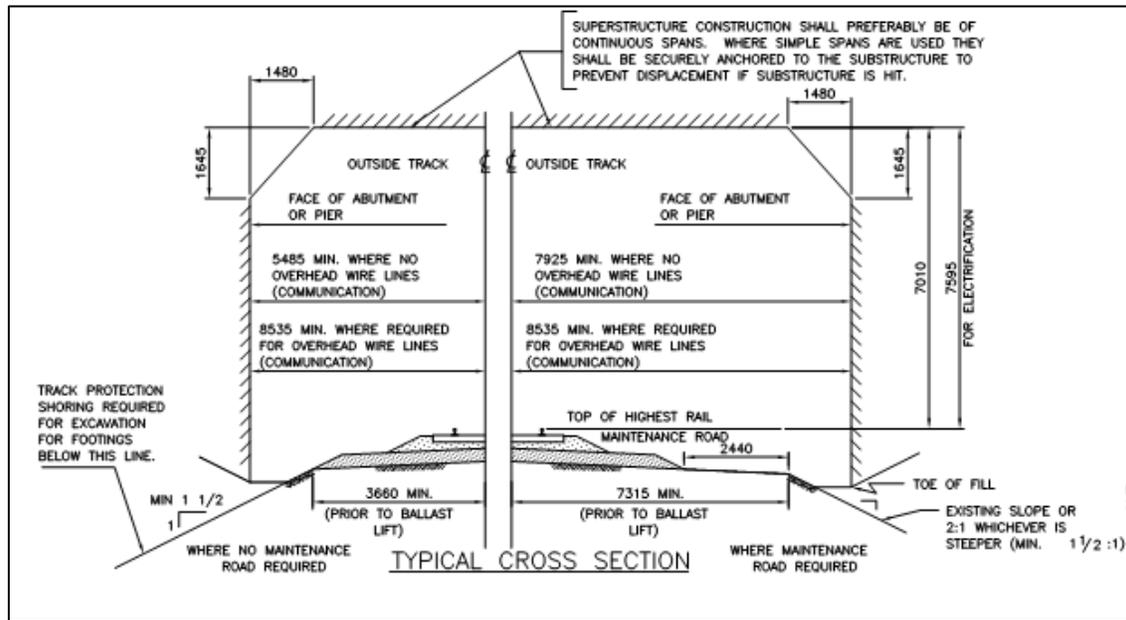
Figure C - Détails des plans de coupes transversales typiques de Metrolinx K1U-10.2m
